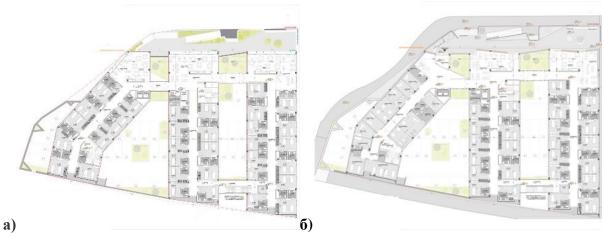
Дом престарелых в Олейросе / TCU Arquitectos а) план первого этажа б) план типового этажа
